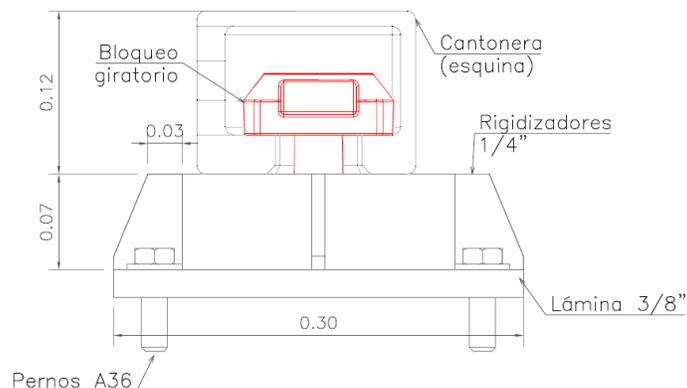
Alzado del mecanismo de anclaje para contenedores. Elaboración propia. 2021.
